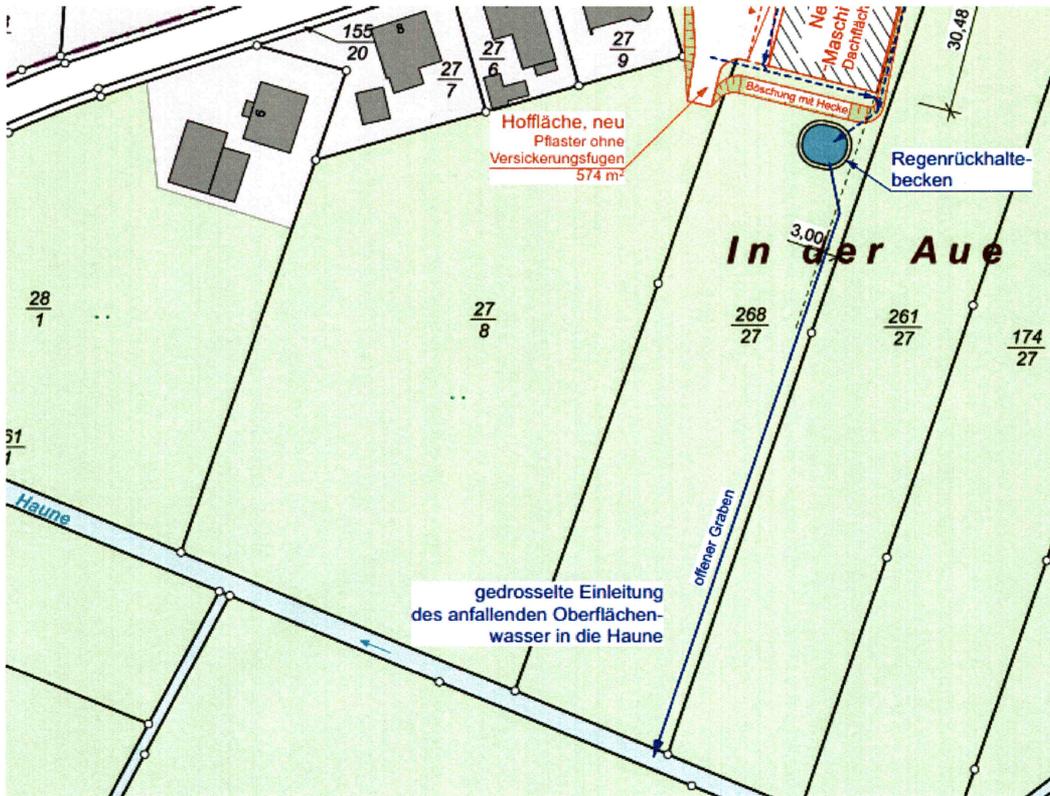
Lageplan v. 04.12.2023, Gensler Architekten, 36157 Ebersburg
